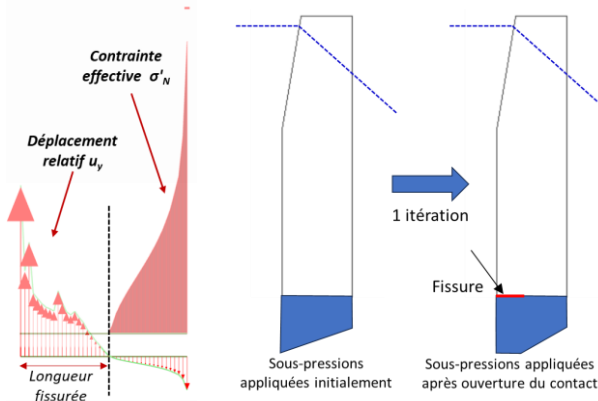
Principe de la longueur fissurée (gauche) et des sous-pressions au contact barrage-fondation (droite)
